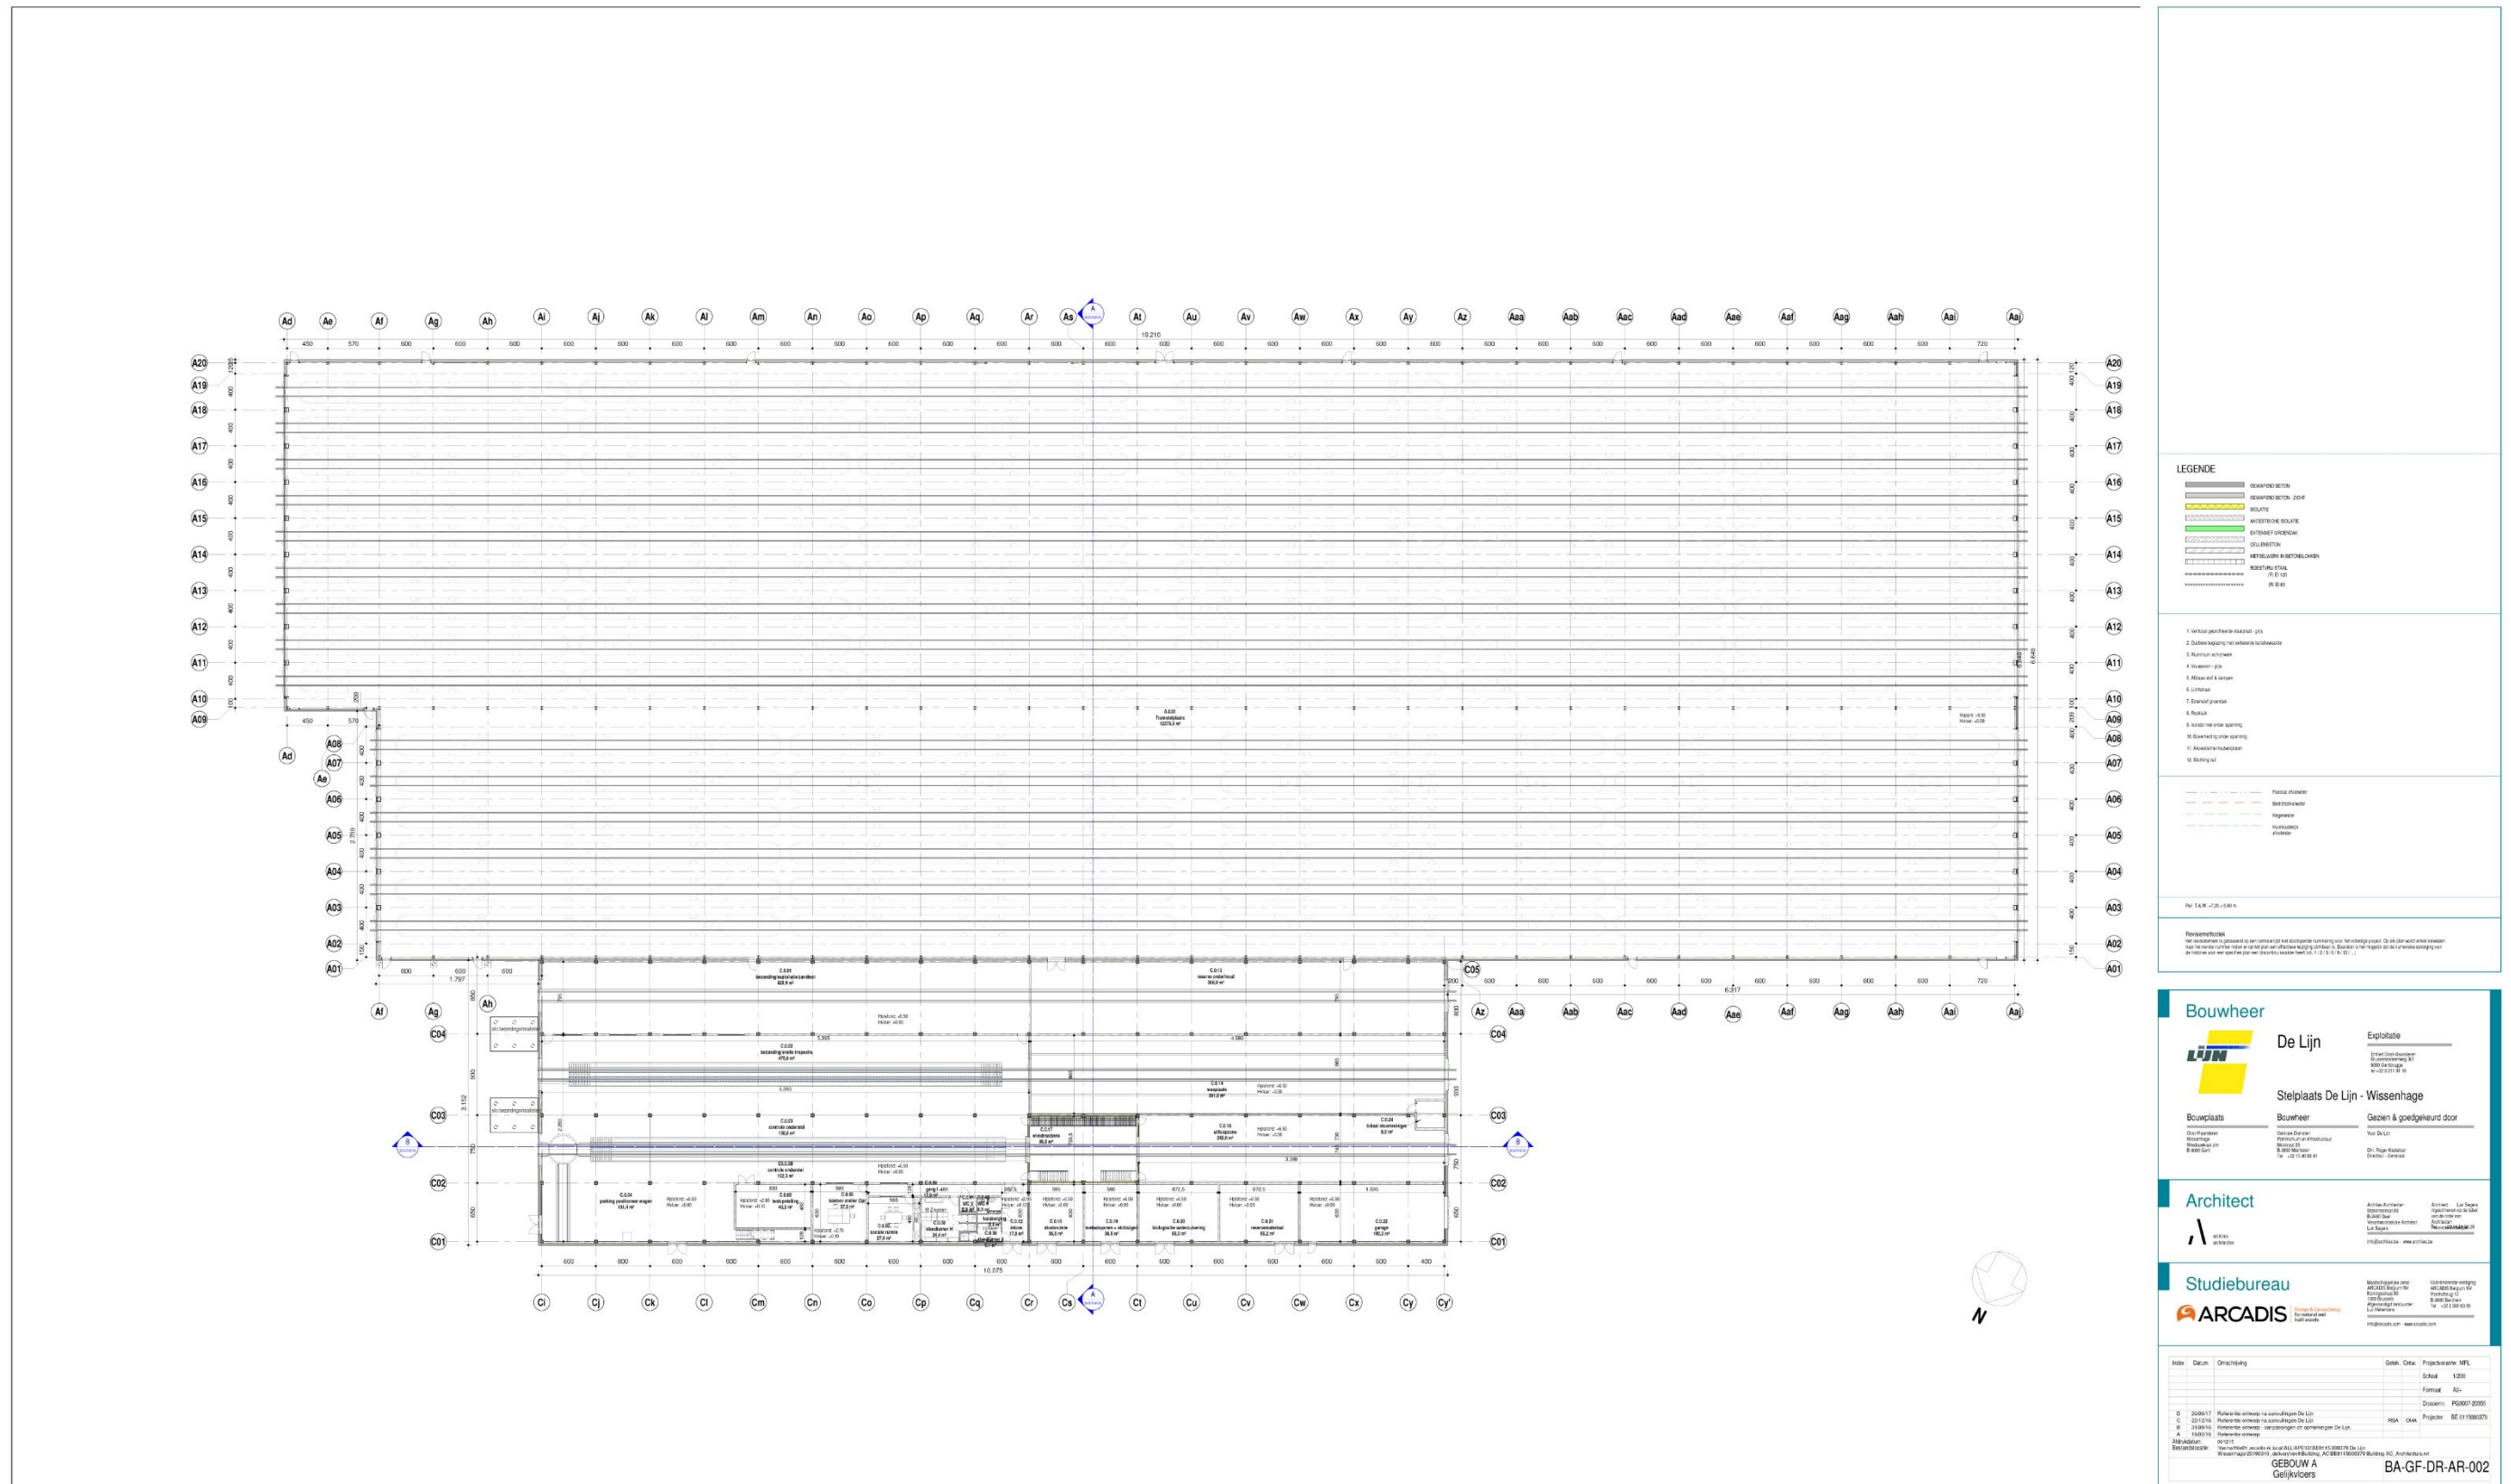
Ontwerpplan bovenleiding – deel 3 (Archiles architecten)
